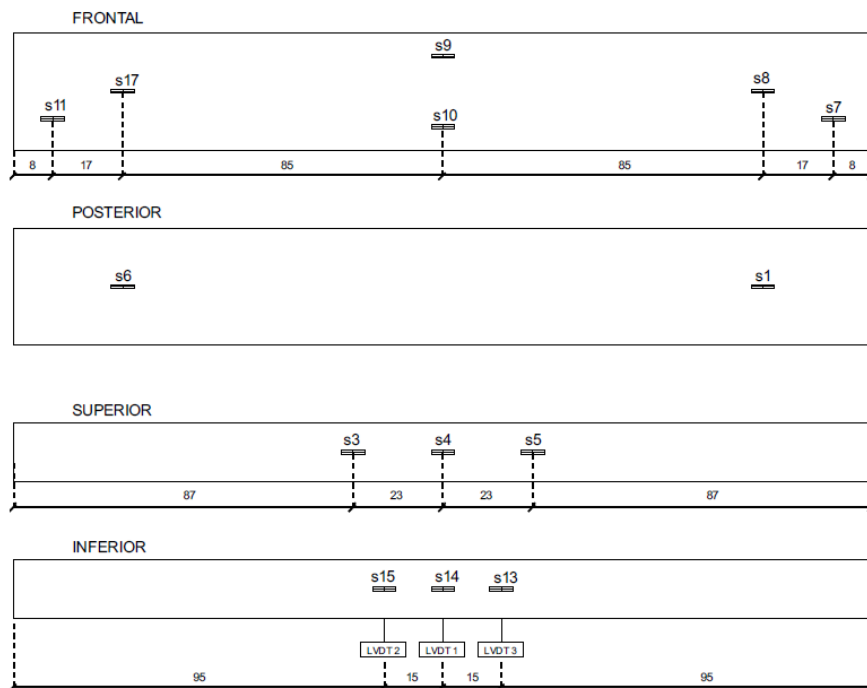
Instrumentação do concreto da viga 1 (medidas em cm)
